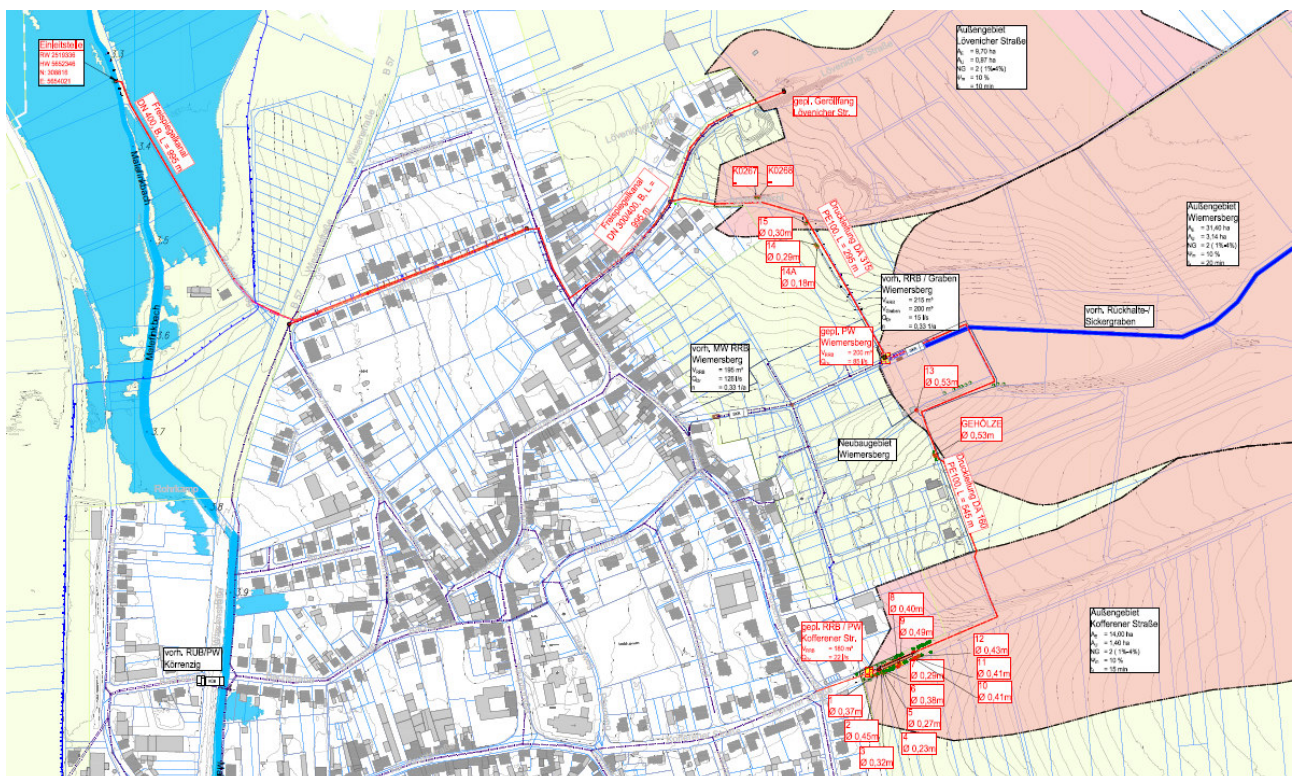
Übersichtslageplan mit eingezeichnetem Trassenverlauf
